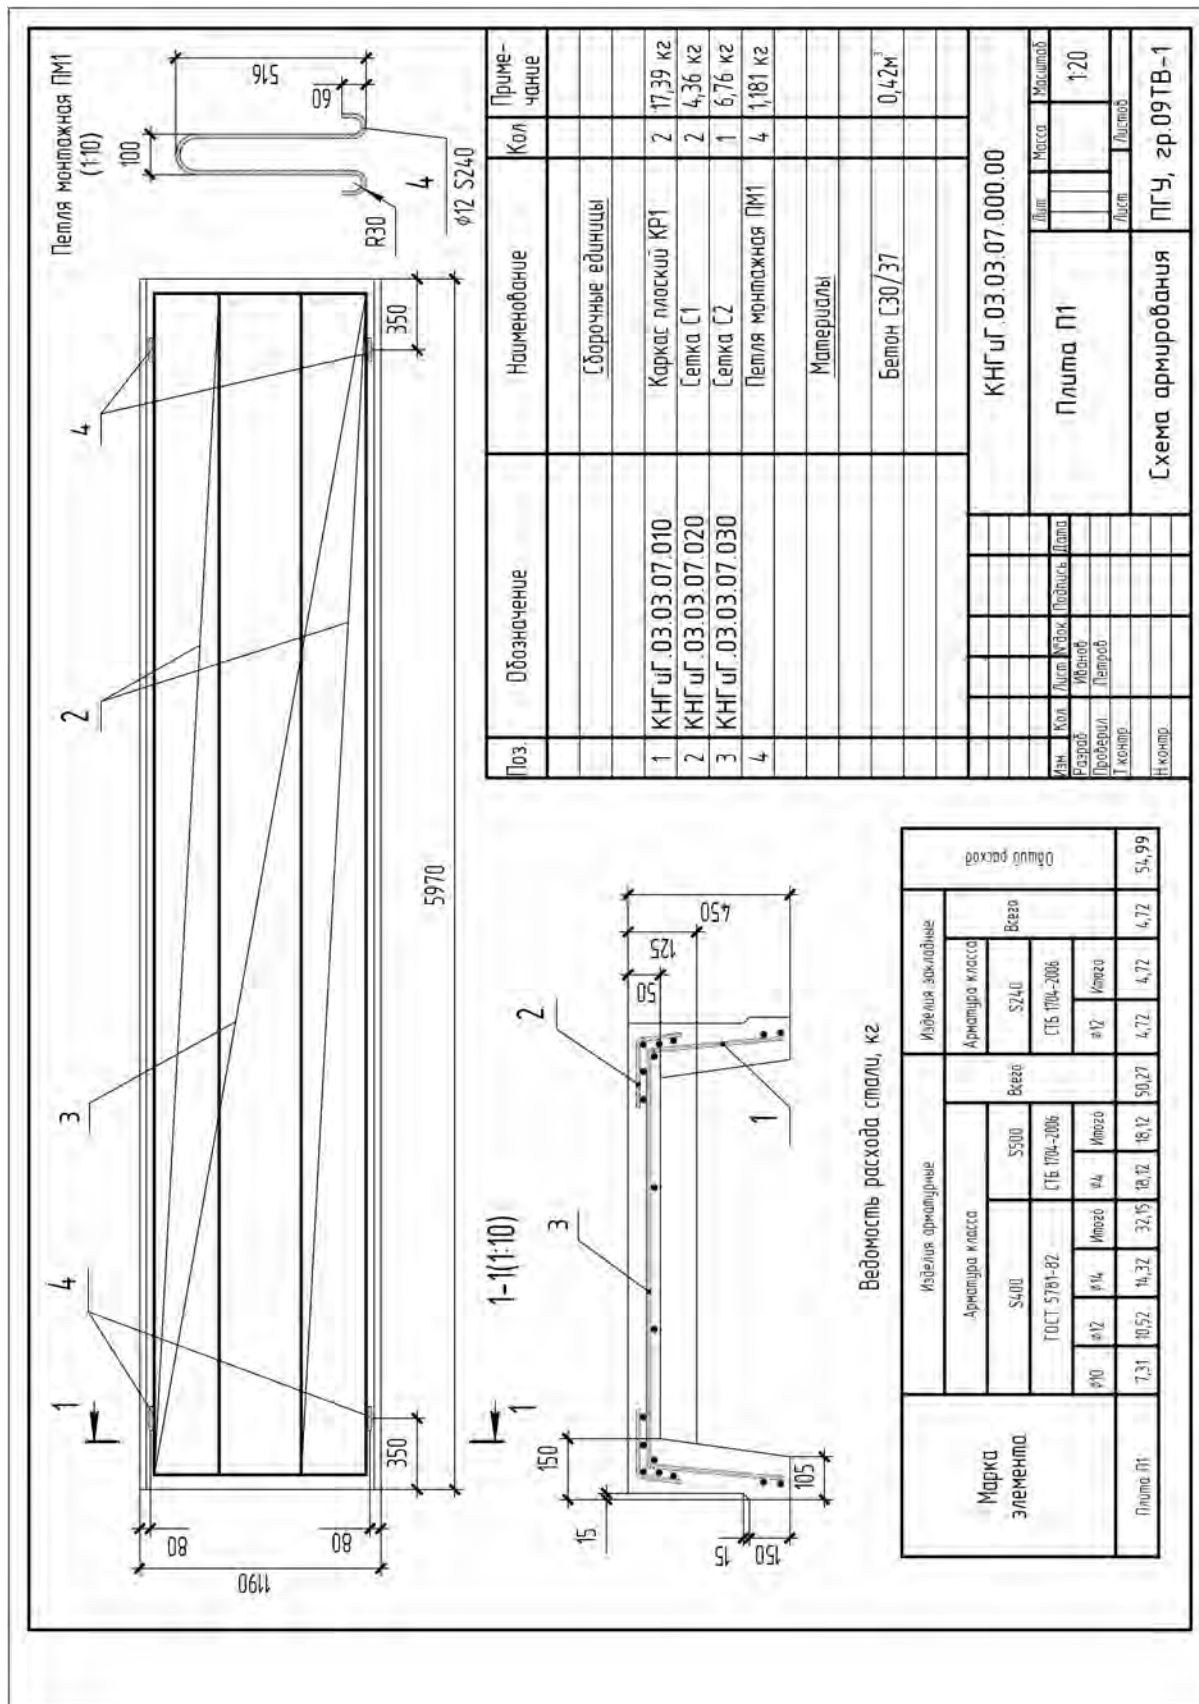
Сборочный чертеж плиты покрытия П1
